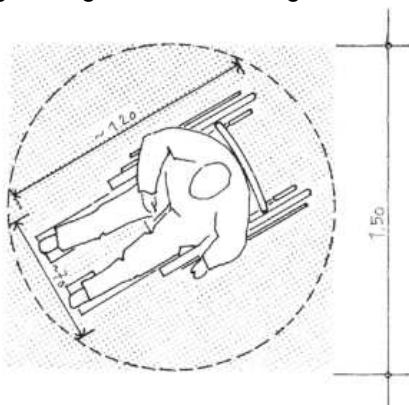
Bewegungsfläche eines Rollstuhlfahrers nach DIN 18025-2
